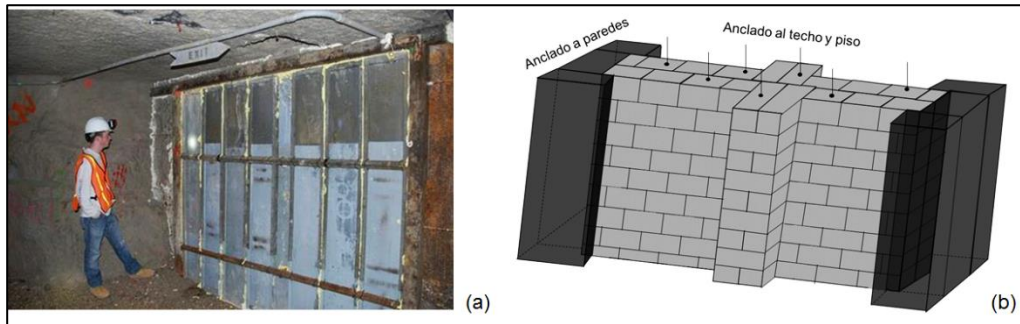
Muros de ventilación: (a) Muro de planchas de metal, y (b) Muro de concreto armado.
